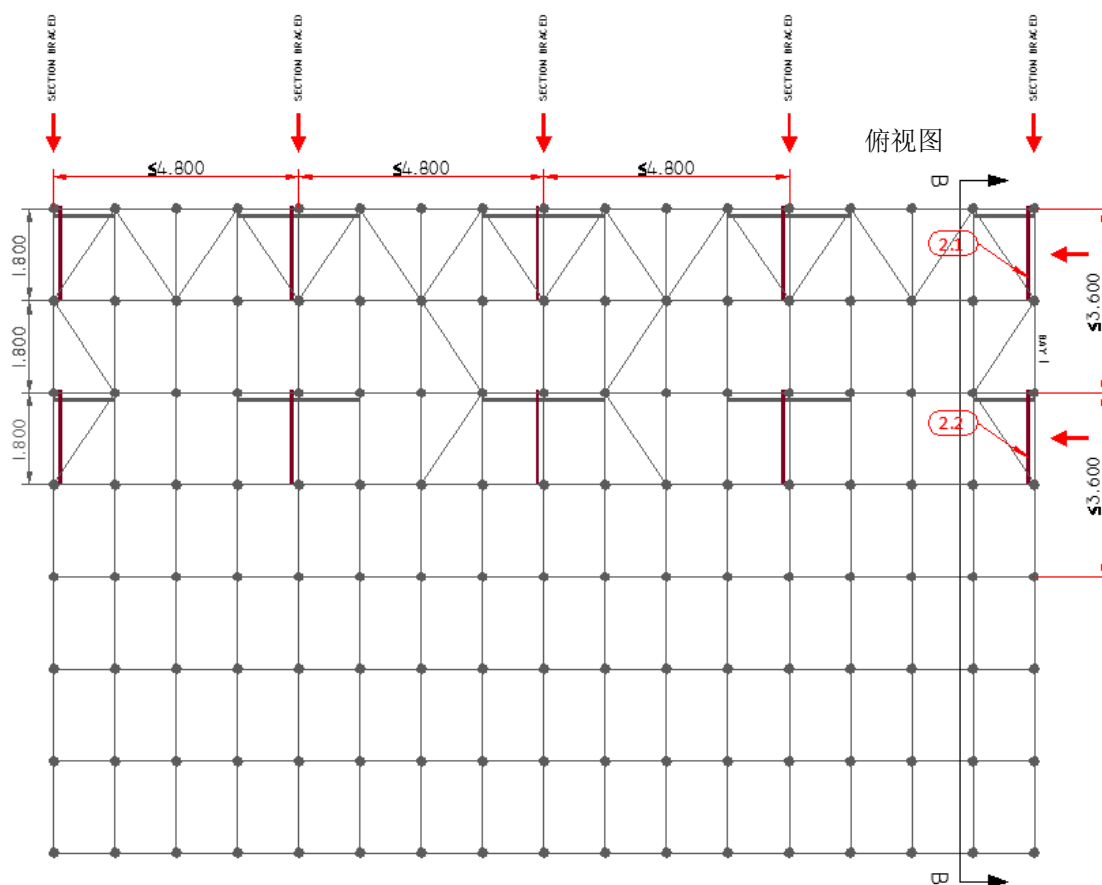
竖向斜杆（横向）支架横间距1.8m 平面图
